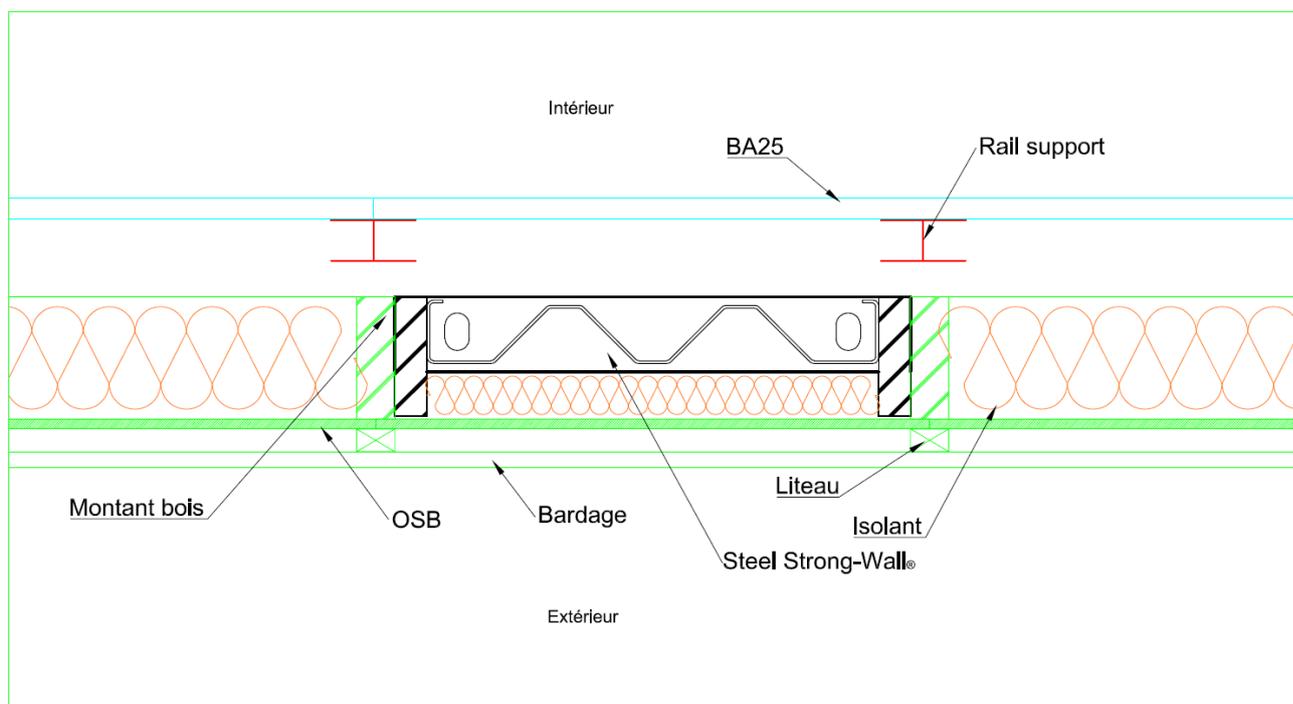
Coupe horizontale - Configuration 1 x plaque 25 mm
